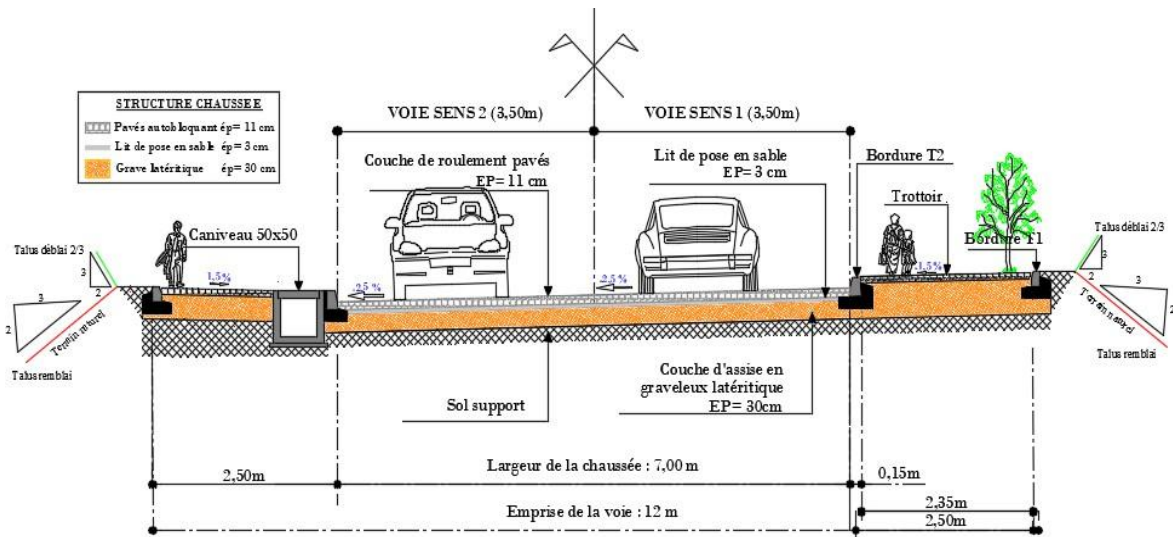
Profil en travers type 2 de l'axe 1 du P07 au P35 (chaussée de 7,00 m)
